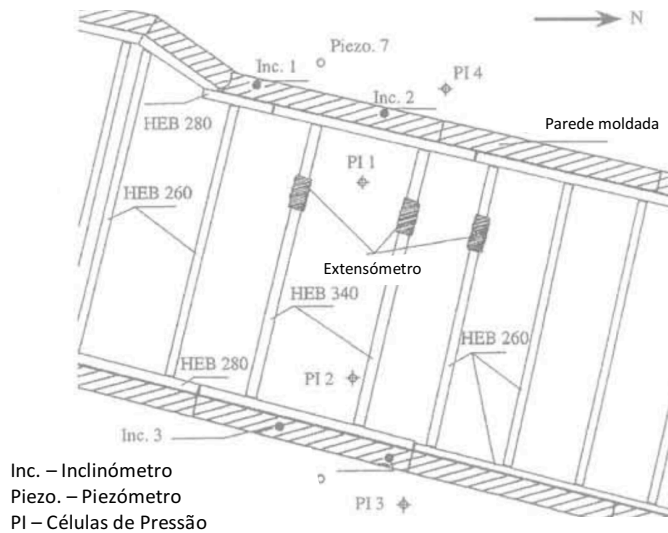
Vista em planta do plano de instrumentação (adaptado^[10], 2003)
